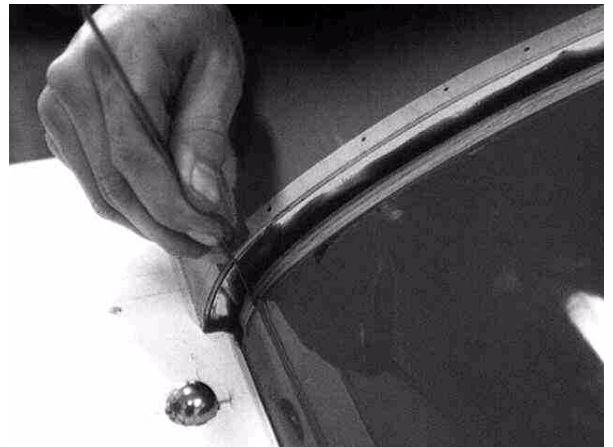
Sämtliche Fugen werden mit Kitt gefüllt
